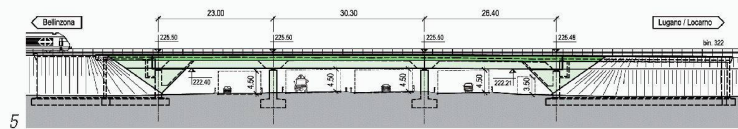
à 7 : Profil longitudinal, plan et coupe transversale du passage sur l'autoroute A2
